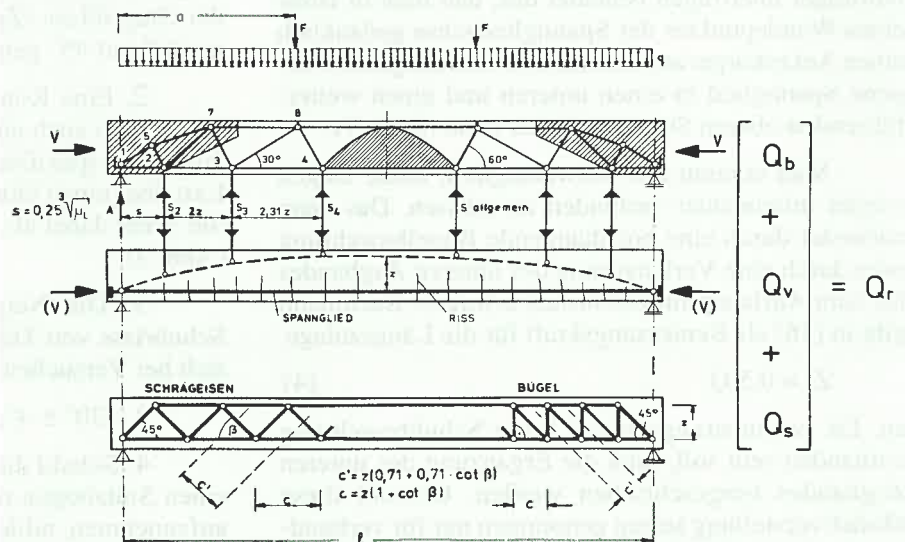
Das dreiteilige Querkraft-Tragmodell eines Stahlbetonträgers mit beliebigem Vorspanngrad
